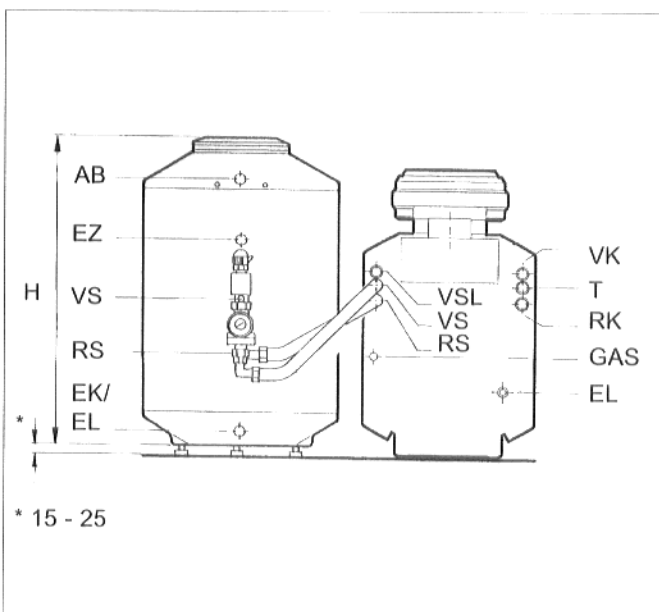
vista posteriore; collegamenti dopo lo spostamento della guaina d'immersione e del tubo di collegamento per la mandata accumulatore
